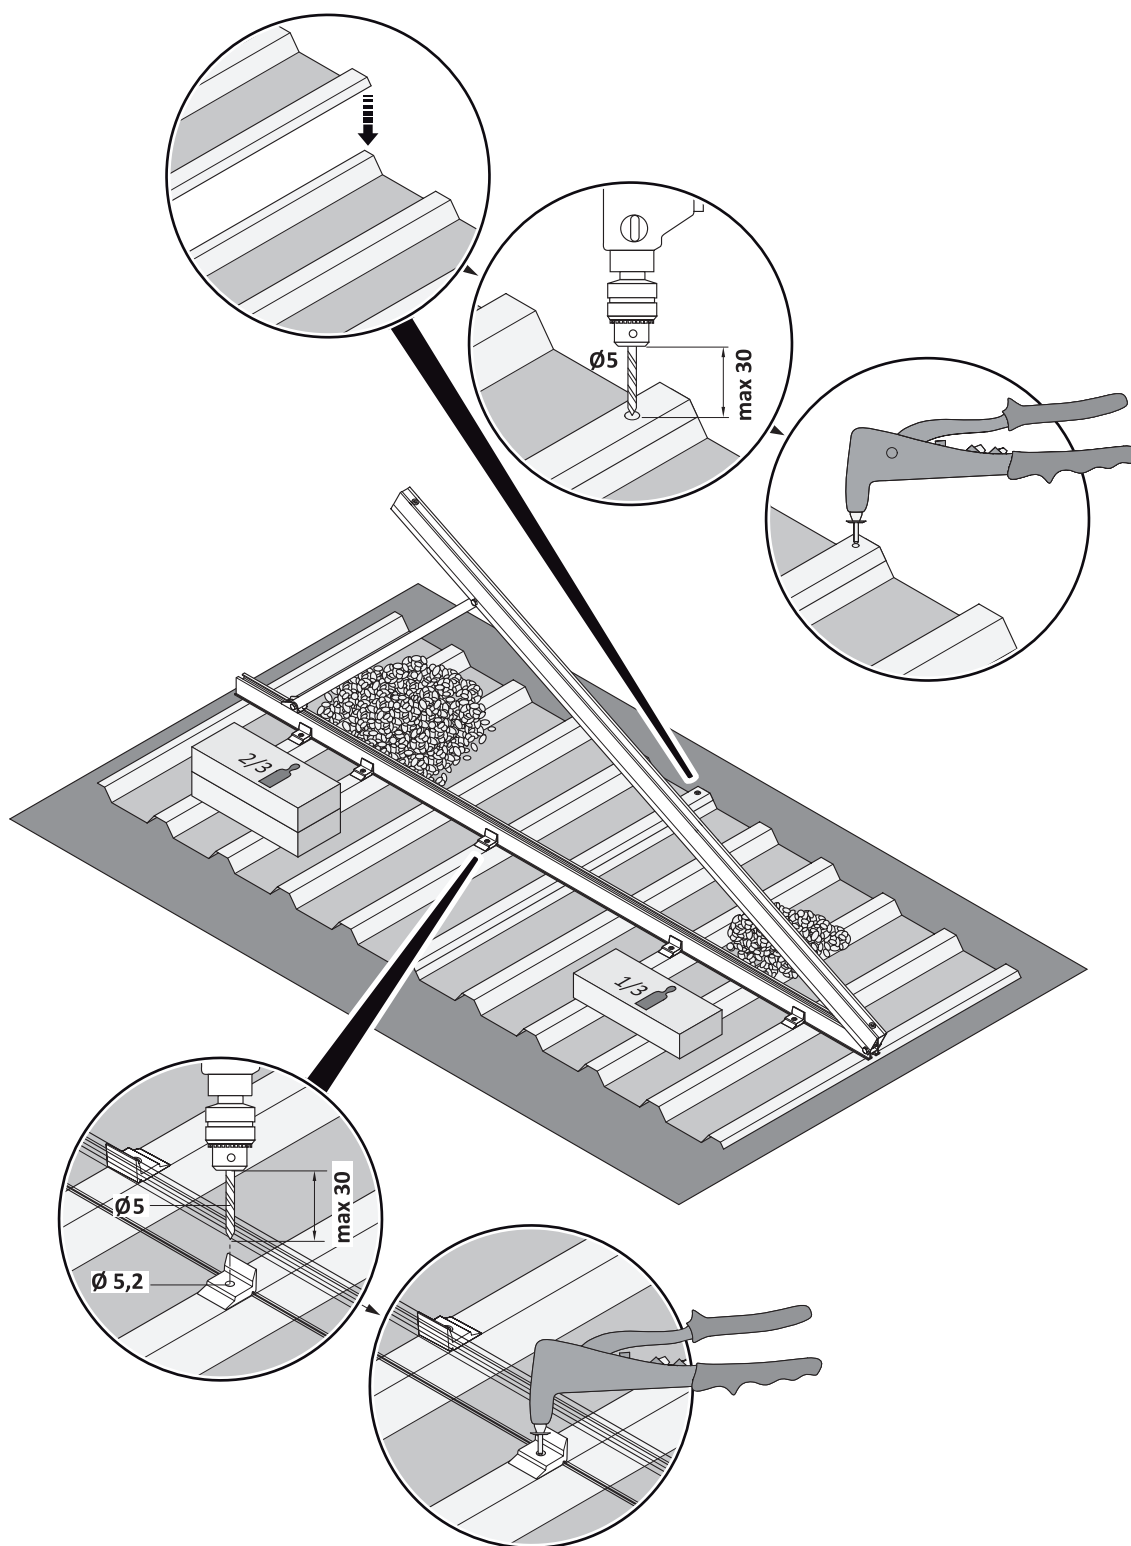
montaggio del supporto per tetto piano su lamiera trapezoidale
